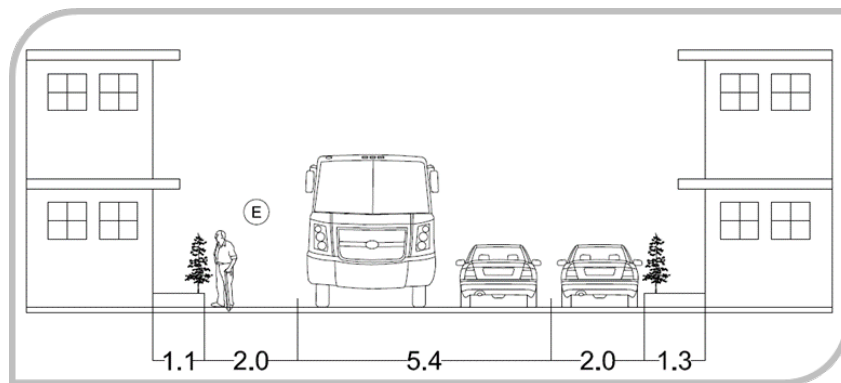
XXII: Sección transversal tipo del tramo 3 Alternativa 2: (elaboración Propia)
